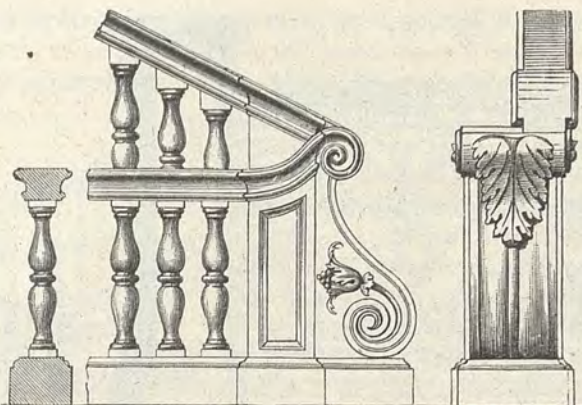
Parapetto della scala sotto la Galleria Nazionale a Torino (ing. Riccio).
